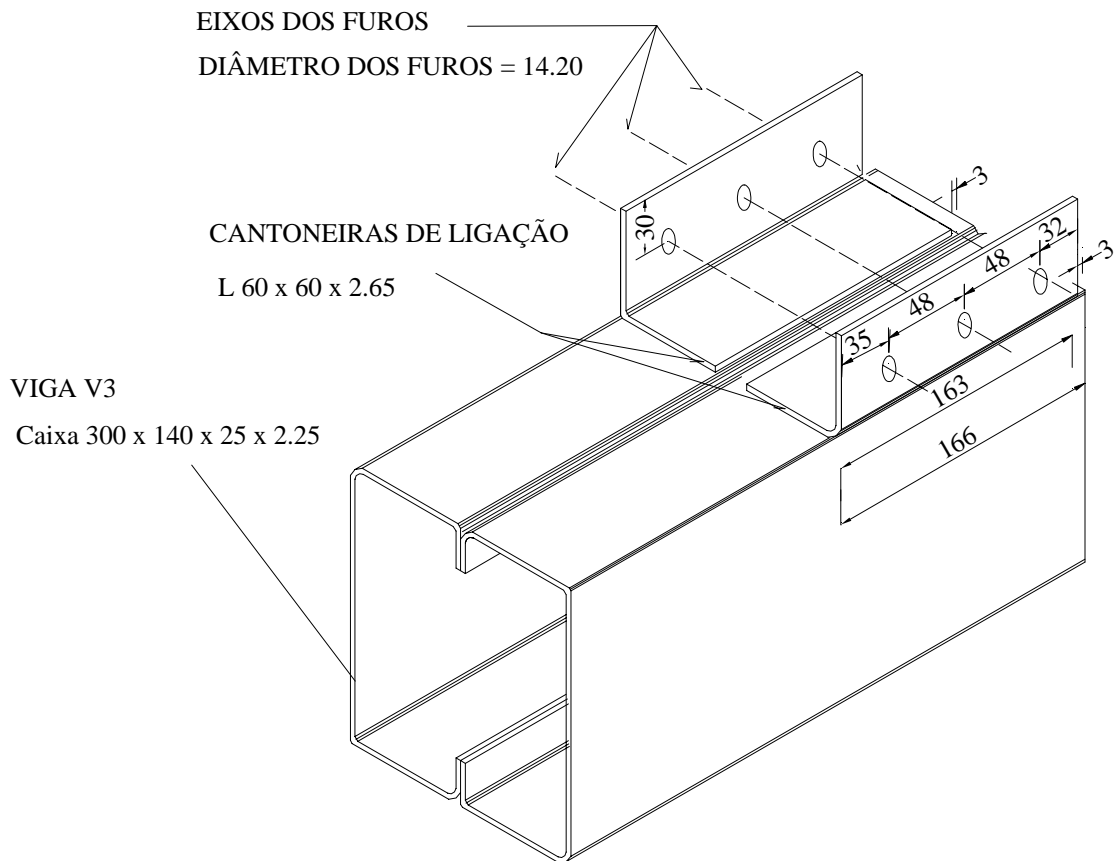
Seções transversais da viga e do pilar utilizados no Protótipo P01.
